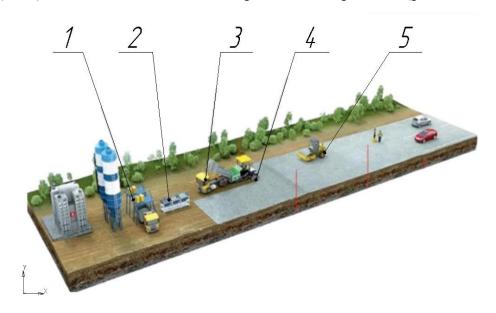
Схема технологического процесса укладки асфальтобетонных покрытий 1 – загрузка автосамосвала асфальтобетонной смесью; 2 – транспортировка смеси до места проведения работ; 3 – перегрузка асфальтобетонной смеси; 4 – укладка асфальтобетонного покрытия; 5 – уплотнение готового полотна
